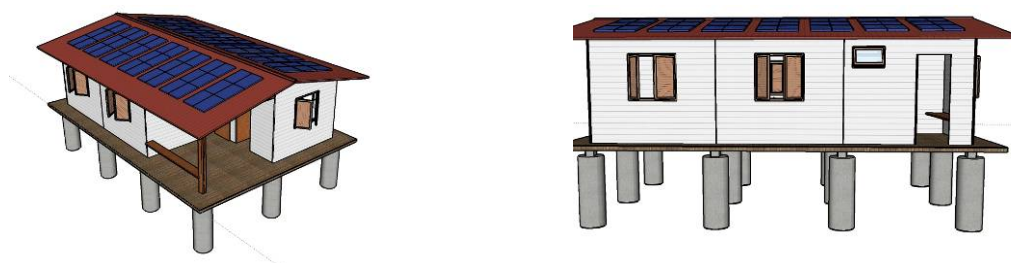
Maquete eletrônica da Segunda ECASPSP, destacando-se que algumas estruturas da fundação (pilaretes) alcançam até 1,80m de altura.
